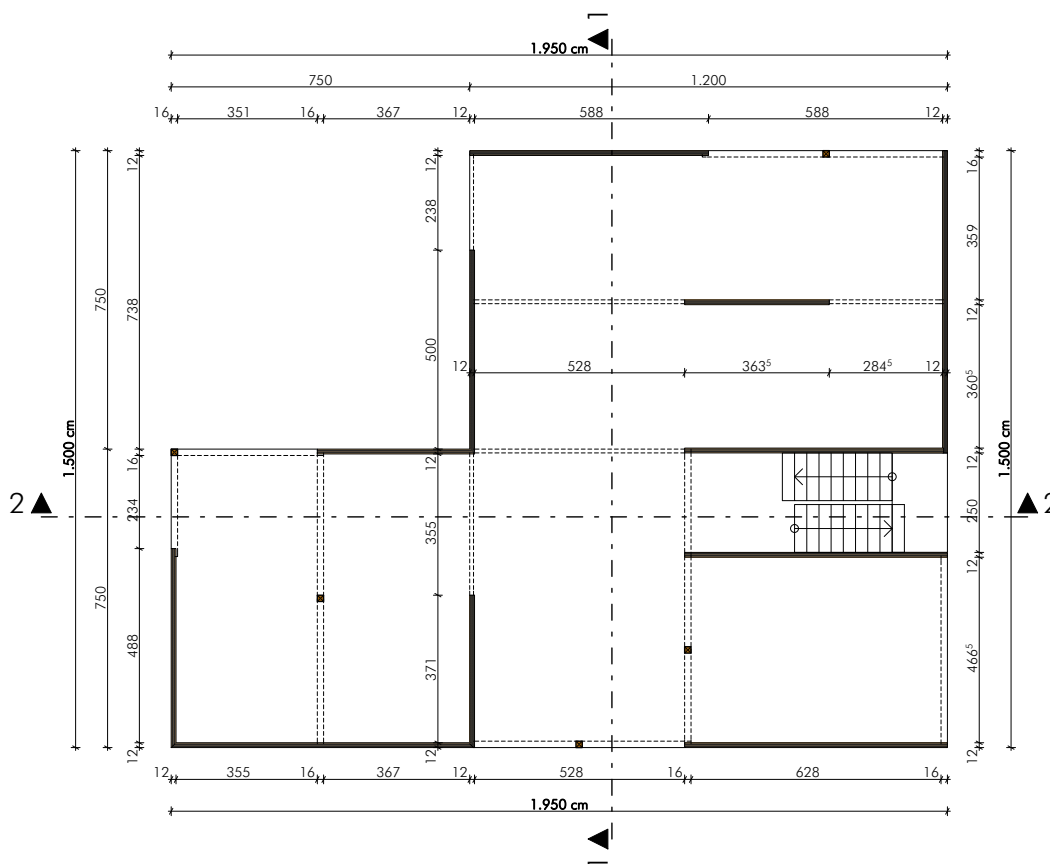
Grundriss des Erdgeschosses des Beispielgebäudes
